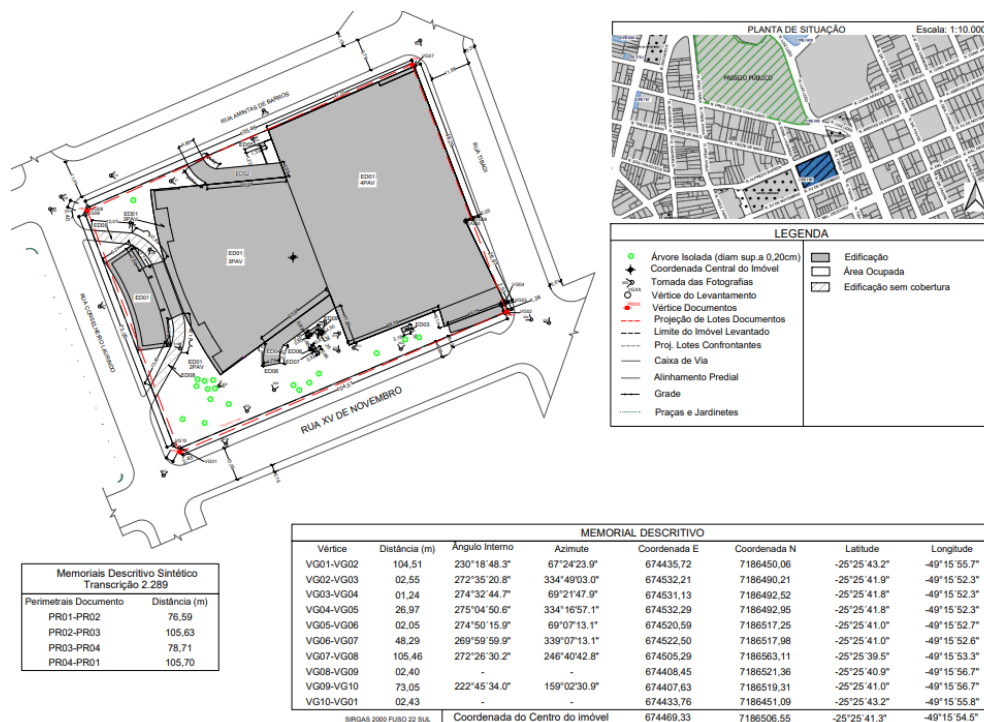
Planta Planimétrica Cadastral do Teatro Guaíra (CPE 106)
